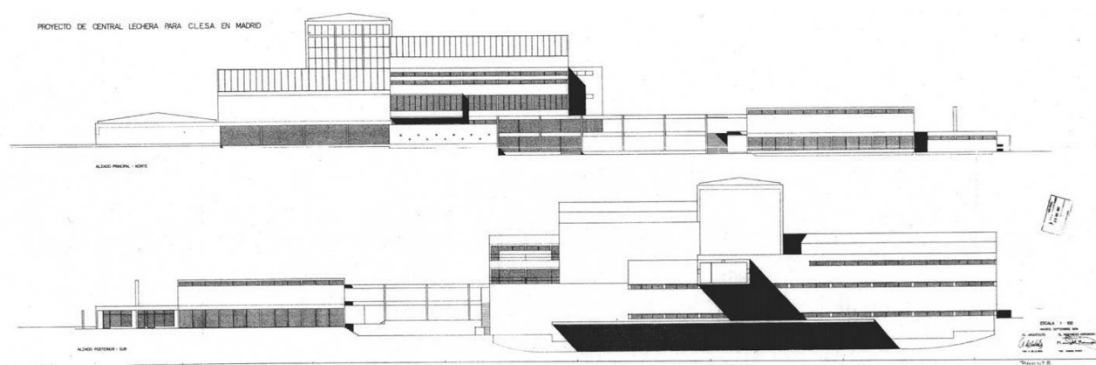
Alzados norte y sur, proyecto 1958. COAM.
